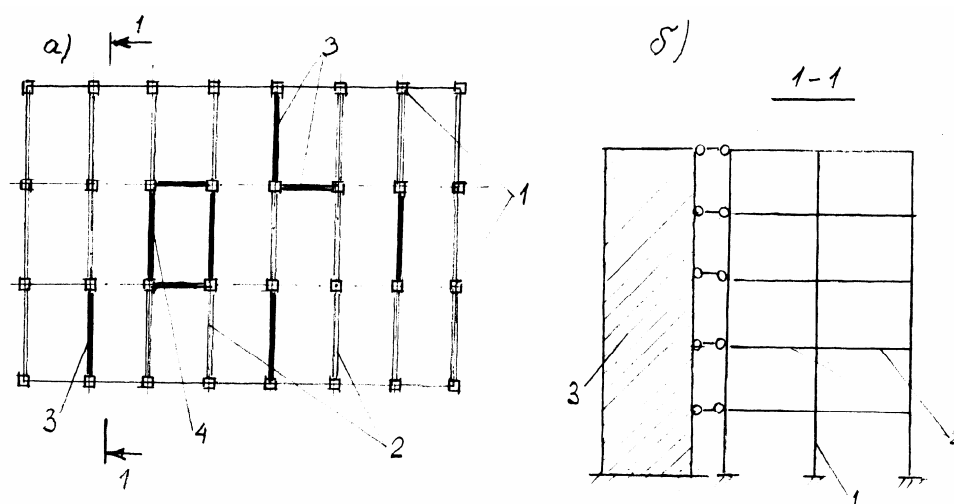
Конструктивна схема багатоповерхового будинку рамно-в'язової системи:
